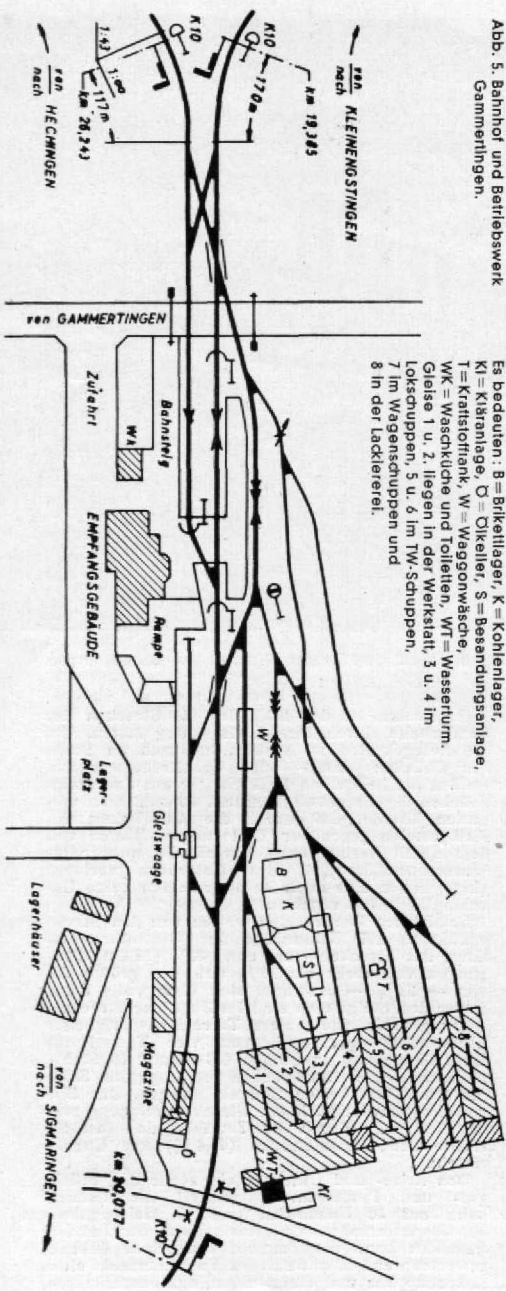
Bahnhof und Betriebswerk Gammertingen.
